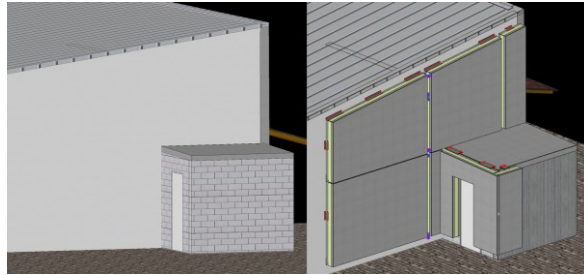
3D-Planung der Demonstrationsfassade in Ausgangslage (links) und saniert mit den Sandwichfassaden-Elementen (rechts)
